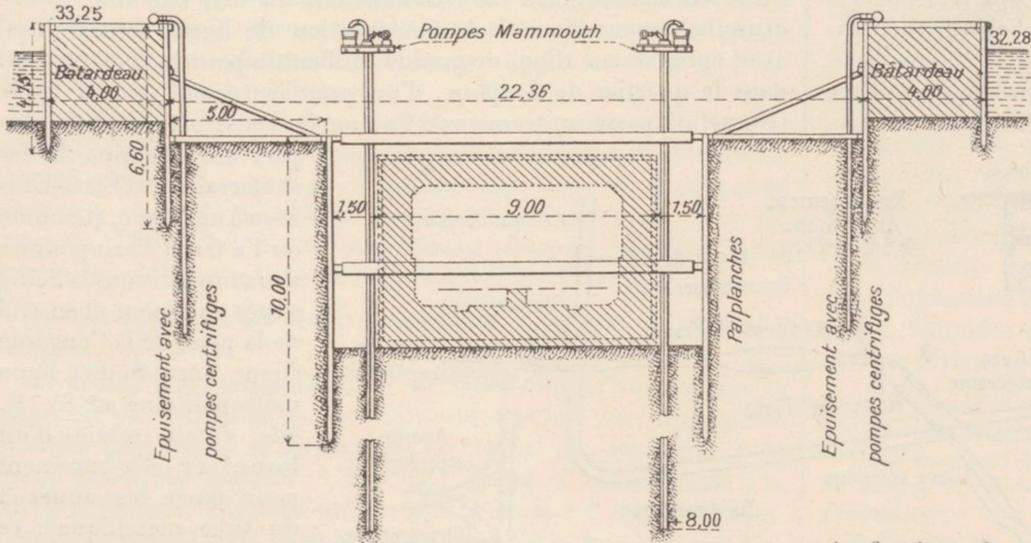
Coupe transversale schématique d'un chantier du tunnel.
